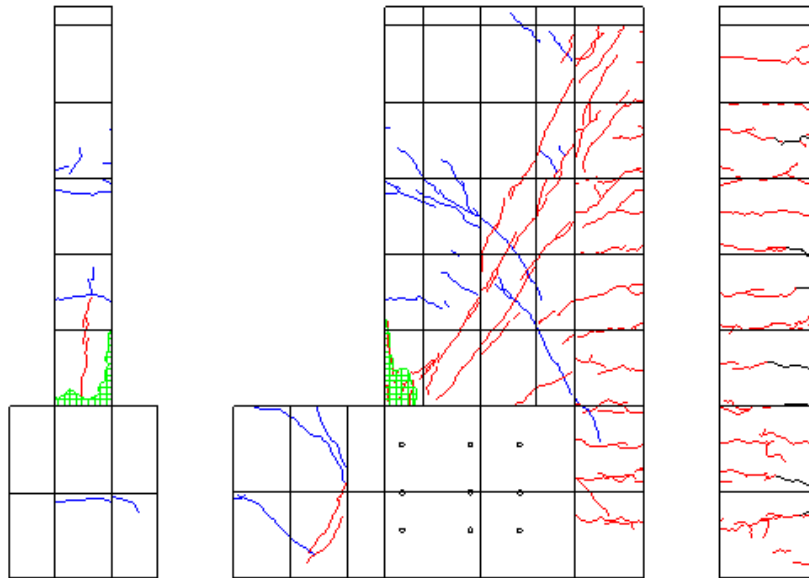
R=-1/67 ひび割れ図
